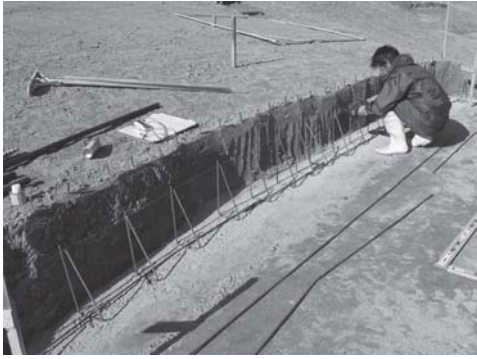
住居跡壁面補強作業（コンクリート基礎と鉄筋の設置）
